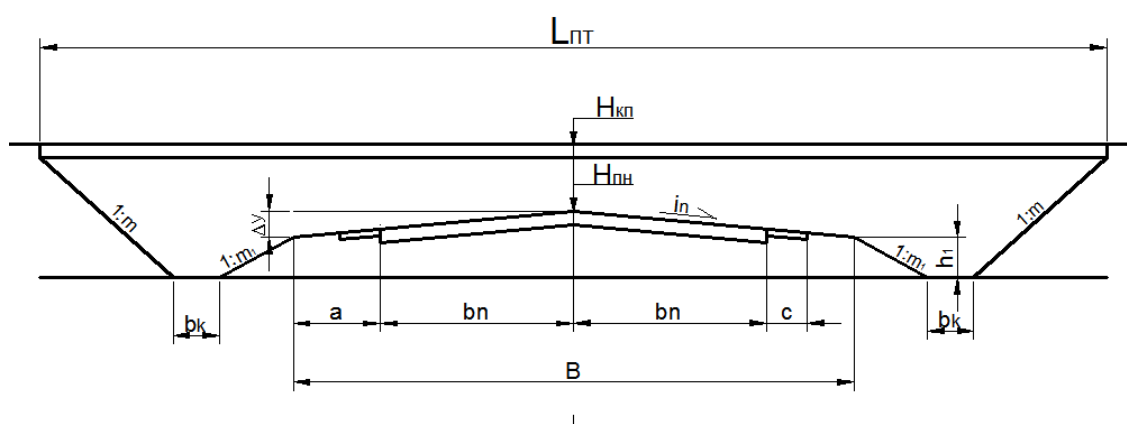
Схема к определению требуемой длины путепровода при прохождении нижней дороги в насыпи
